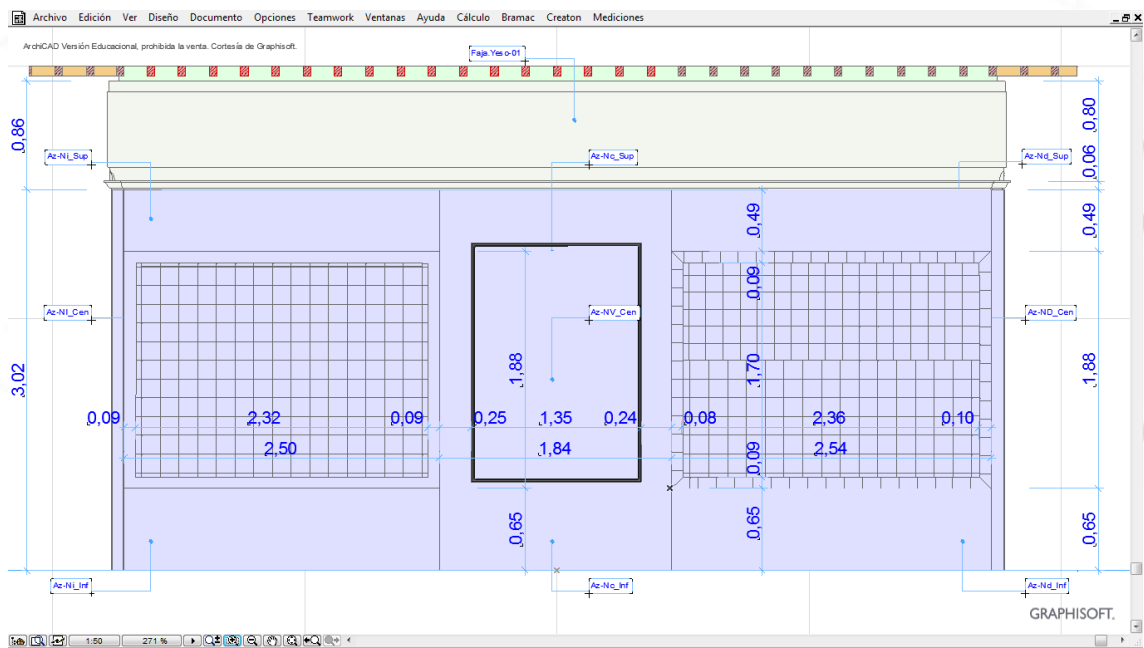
Sectorización de los paños de azulejos en la fachada norte del Cenador. En el alzado de ArchiCAD se ven identificados con etiquetas cada paño y posteriormente acotado. Se ha usado la herramienta Forma.
